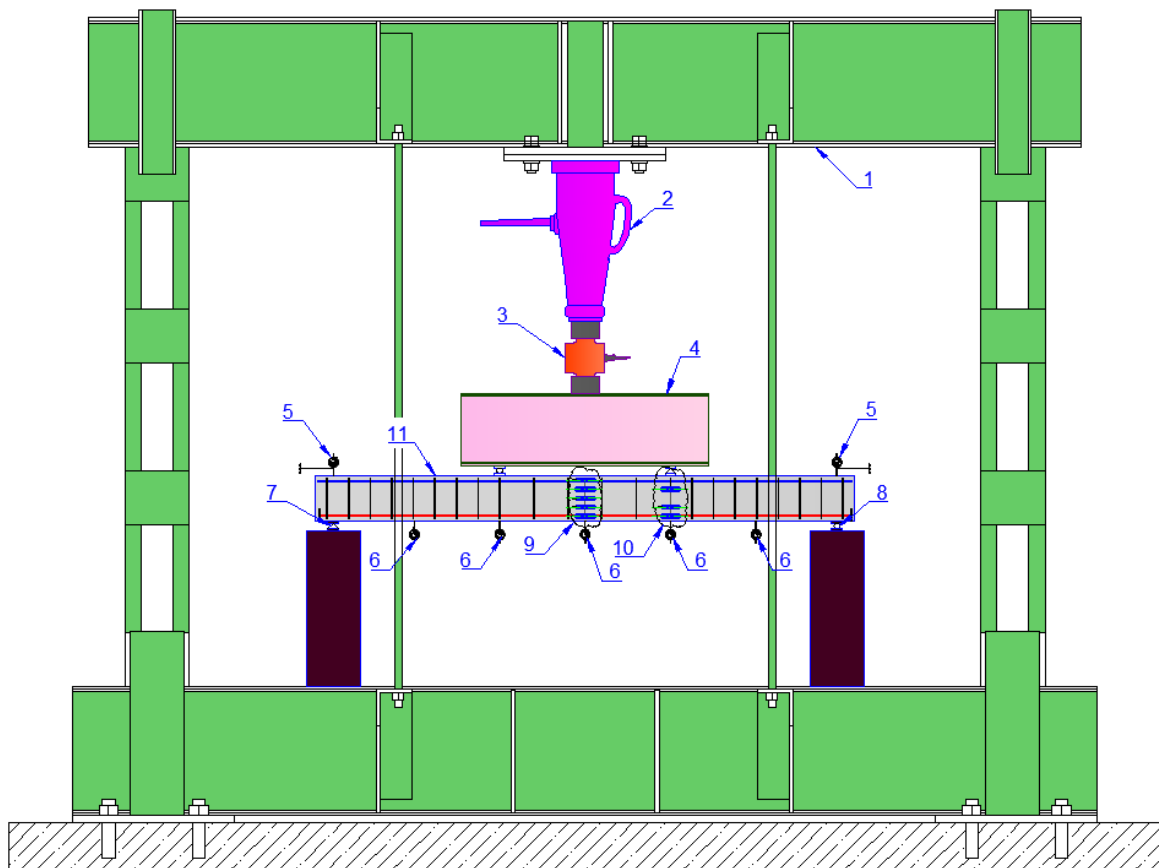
Расчётная схема модельных железобетонных балок с армированием
